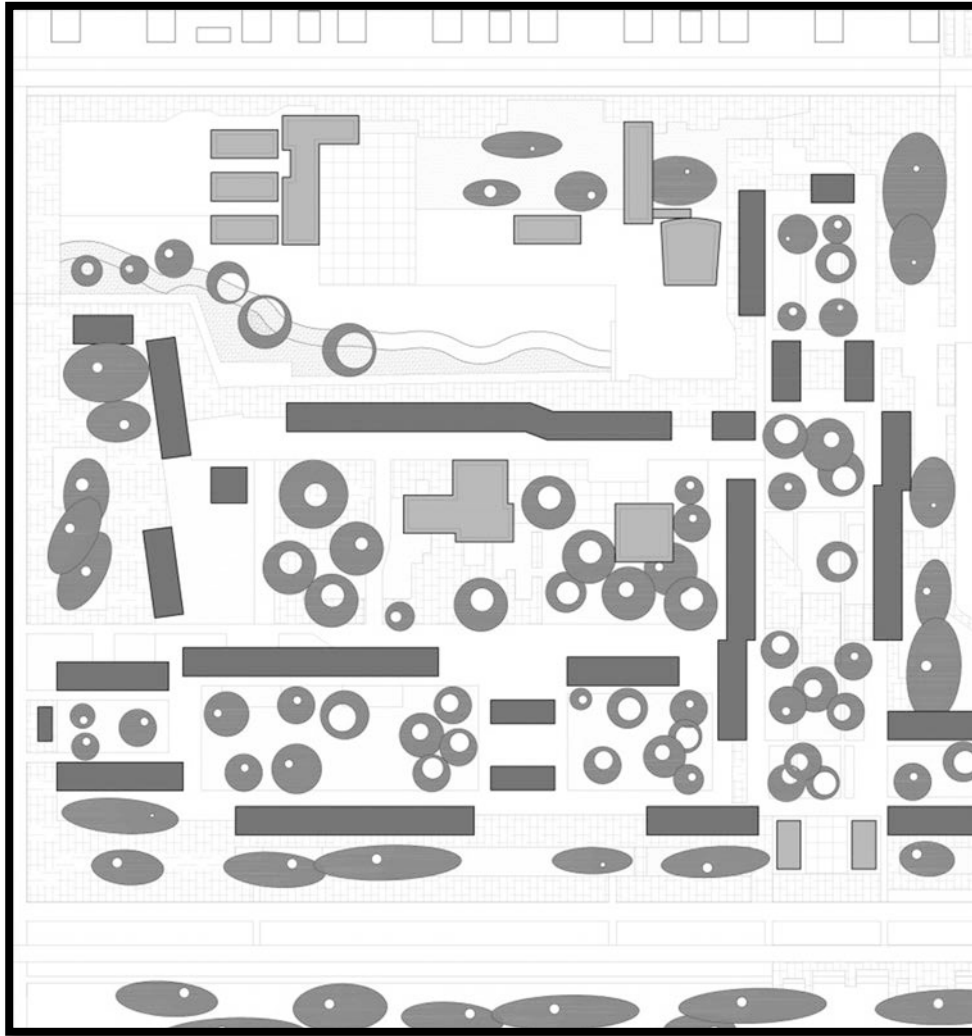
Planta cubiertas. Detalle. Osiedle Kolo (Elaboración propia)
